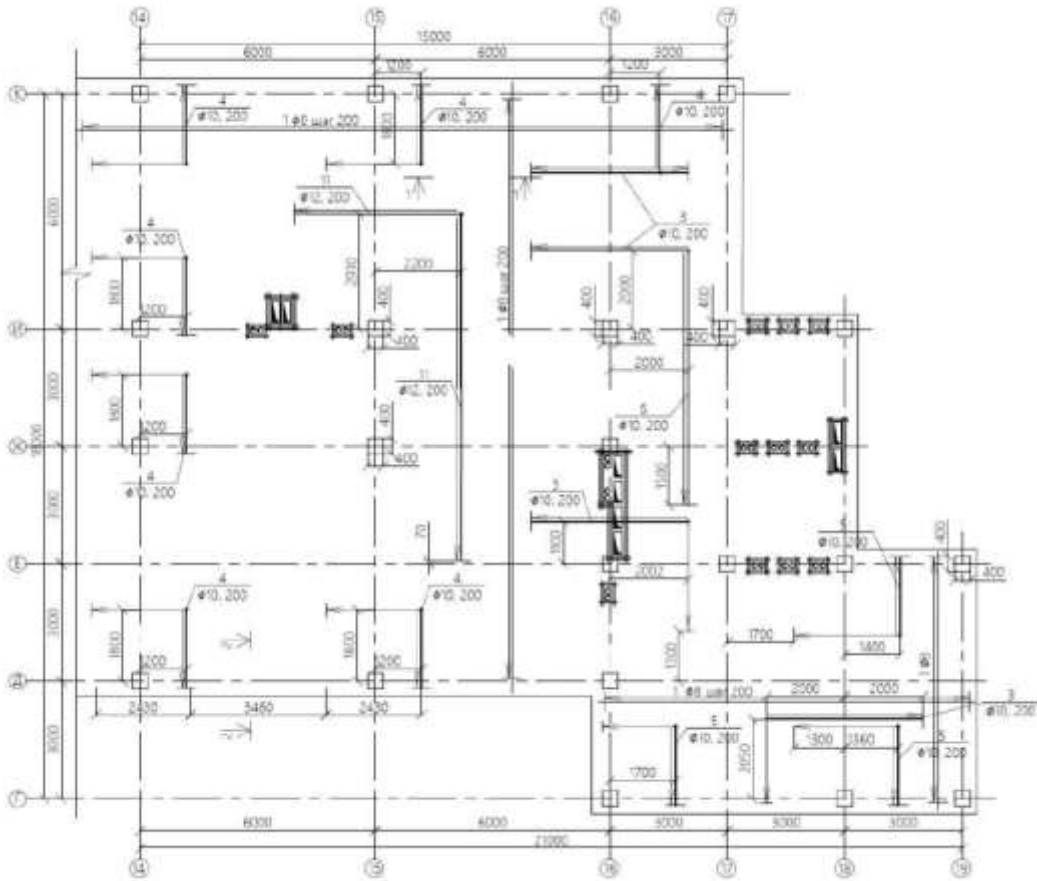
Схема верхнього армування монолітної плити перекриття.
